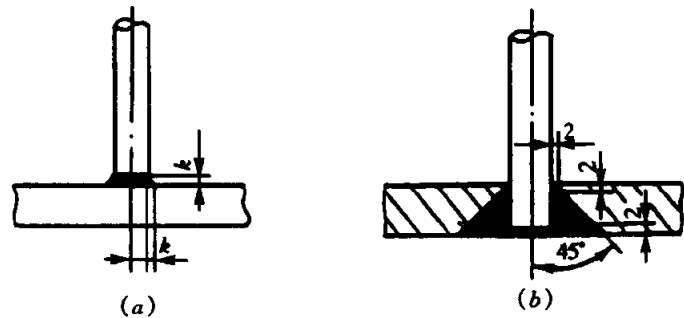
预埋件钢筋电弧焊 T 型接头
